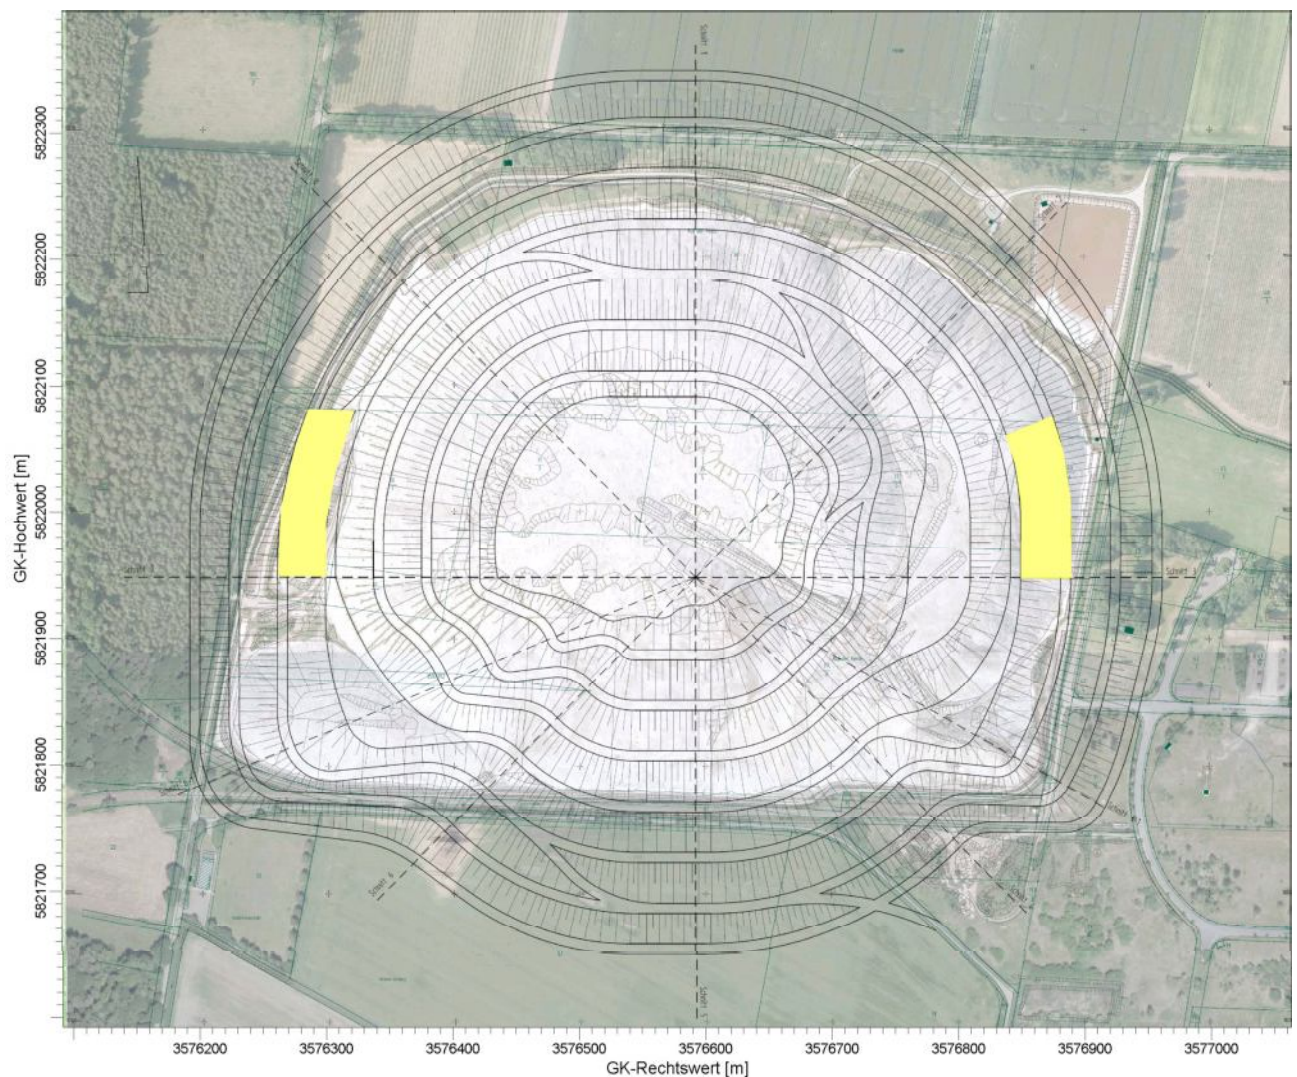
Grundfläche des zukünftigen Haldenkörpers –schwarzmarkiert- (bestehende und geplante Haldenfläche), gelbe Markierungen; berücksichtigten Baufeld für Berechnungsvariante westliche und östliche Flanke
